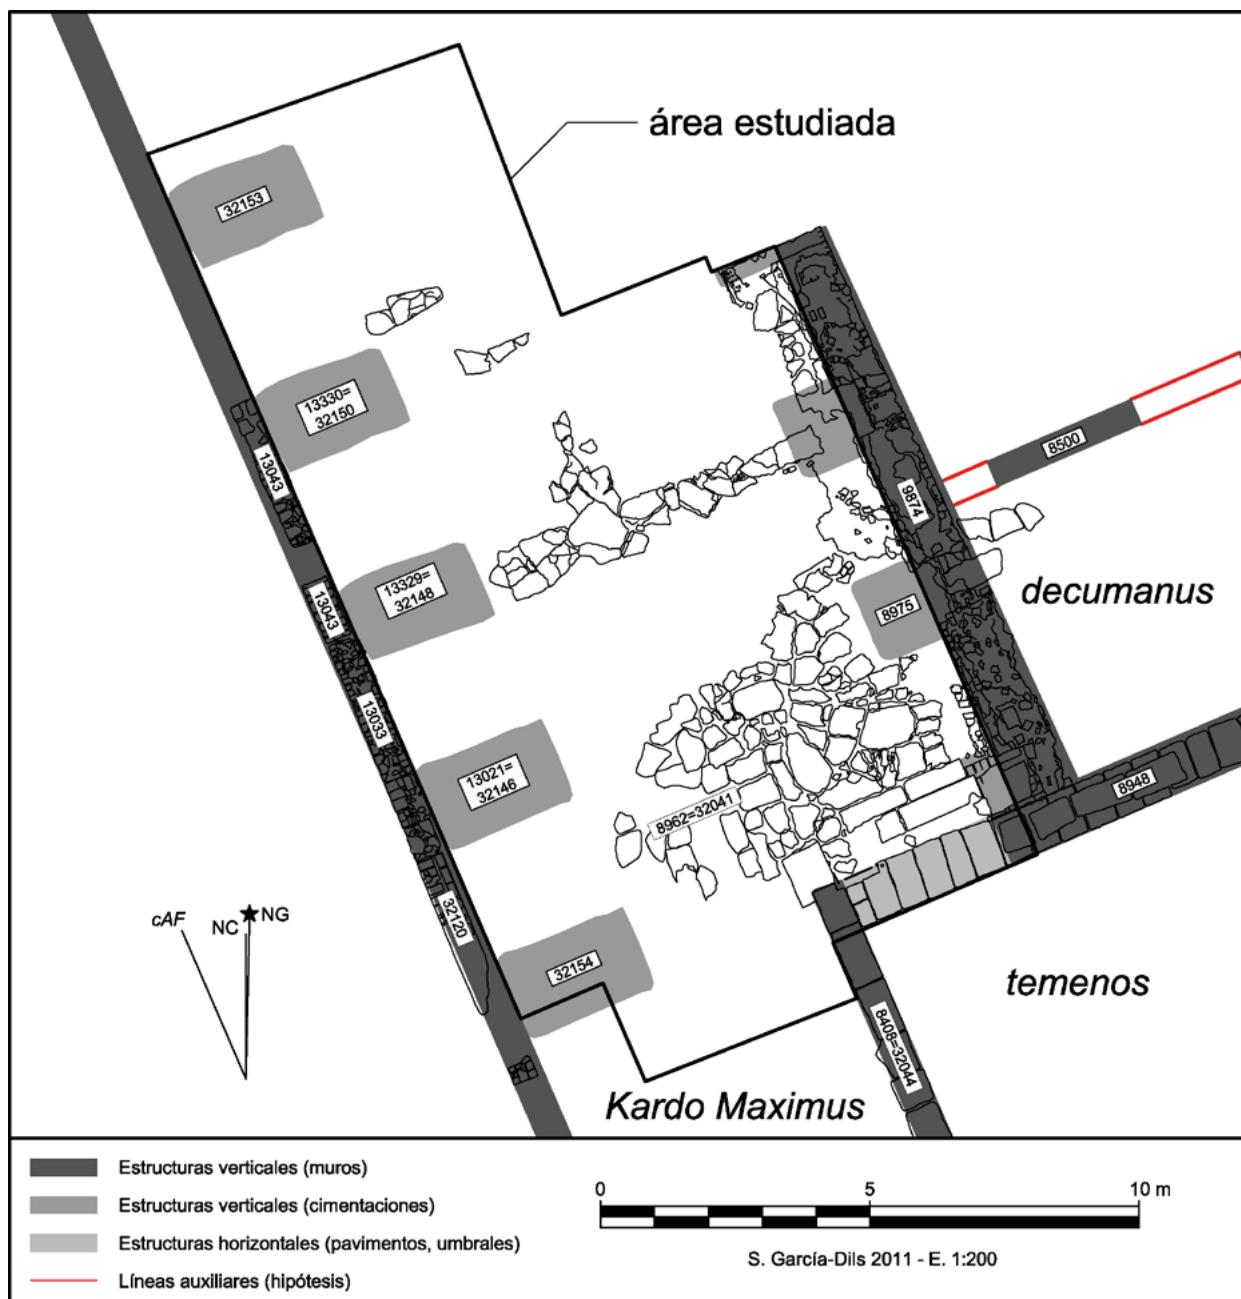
Planta del acceso porticado al *temenos* en su ángulo noroeste (Sergio García-Dils).
